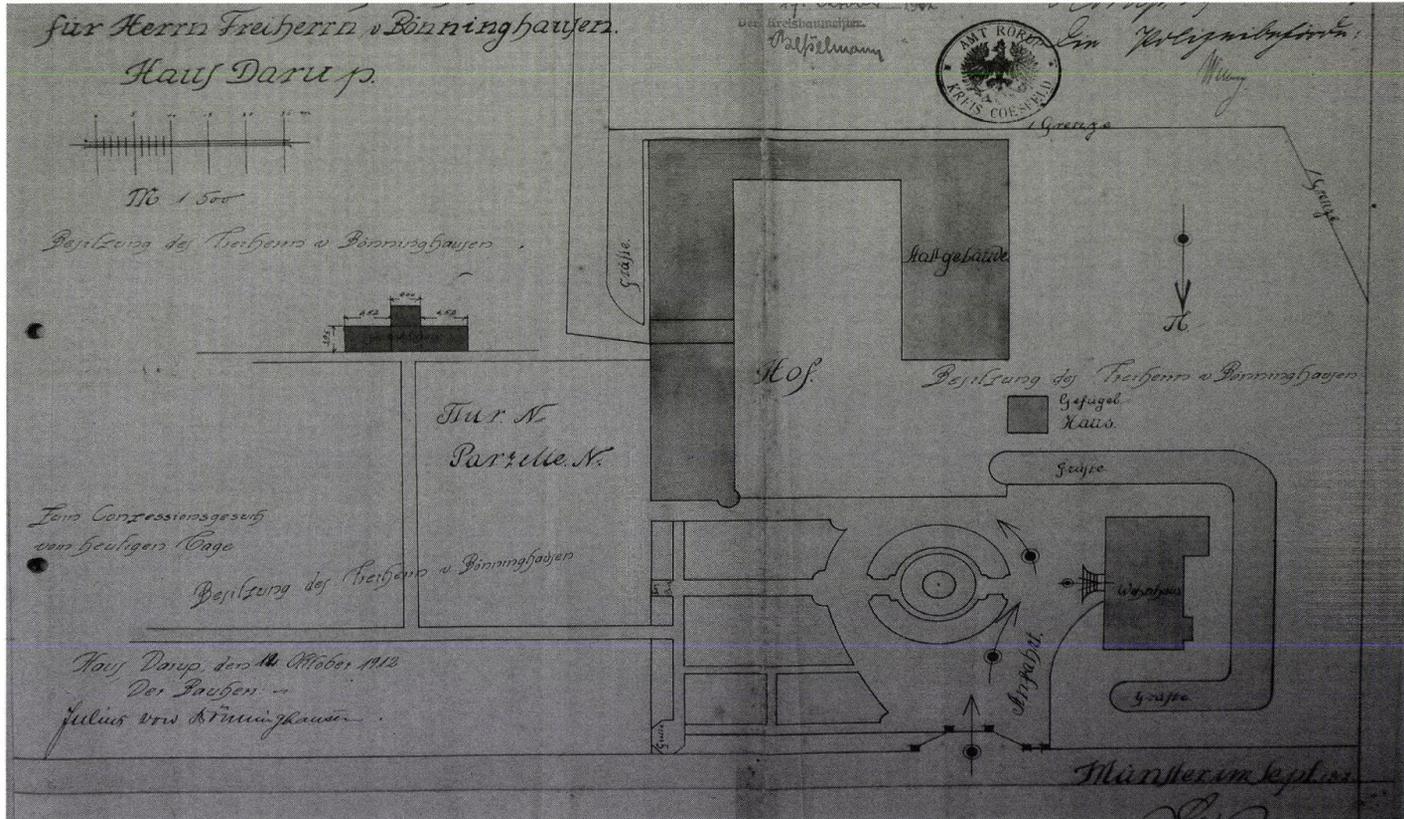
Lageplan zum Neubau eines Gewächshauses auf dem Hause Darup, Oktober 1912, Gemeindearchiv Nottuln.
